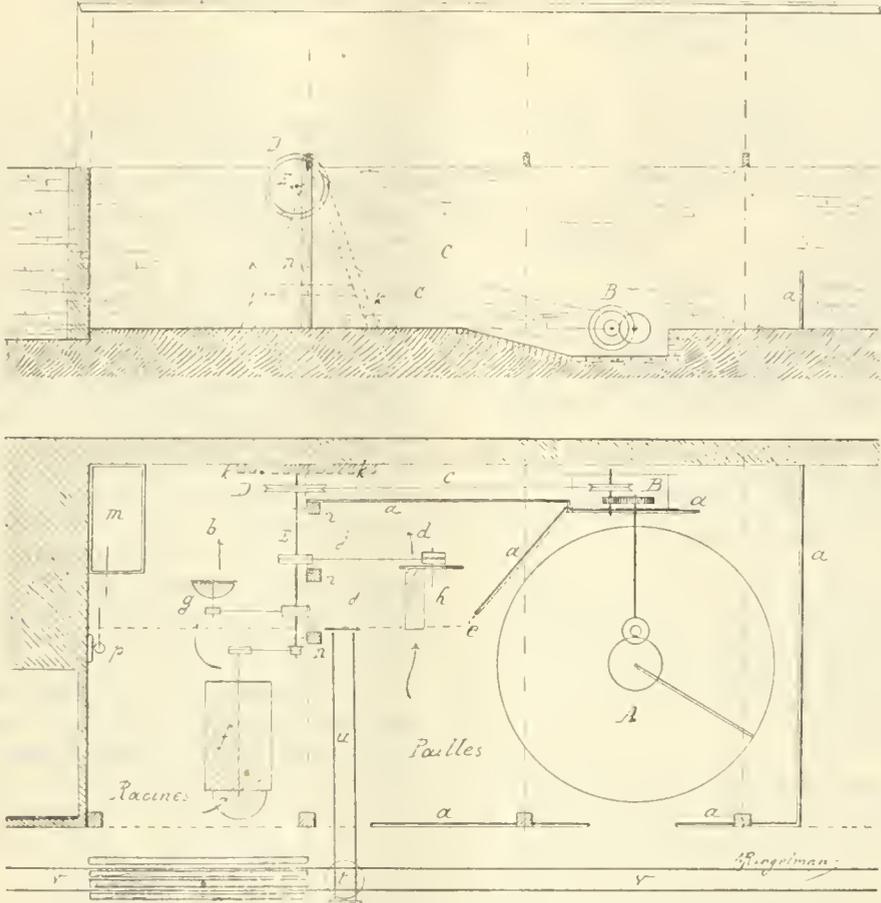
Élévation et plan d'un atelier mû par un manège à terre.
